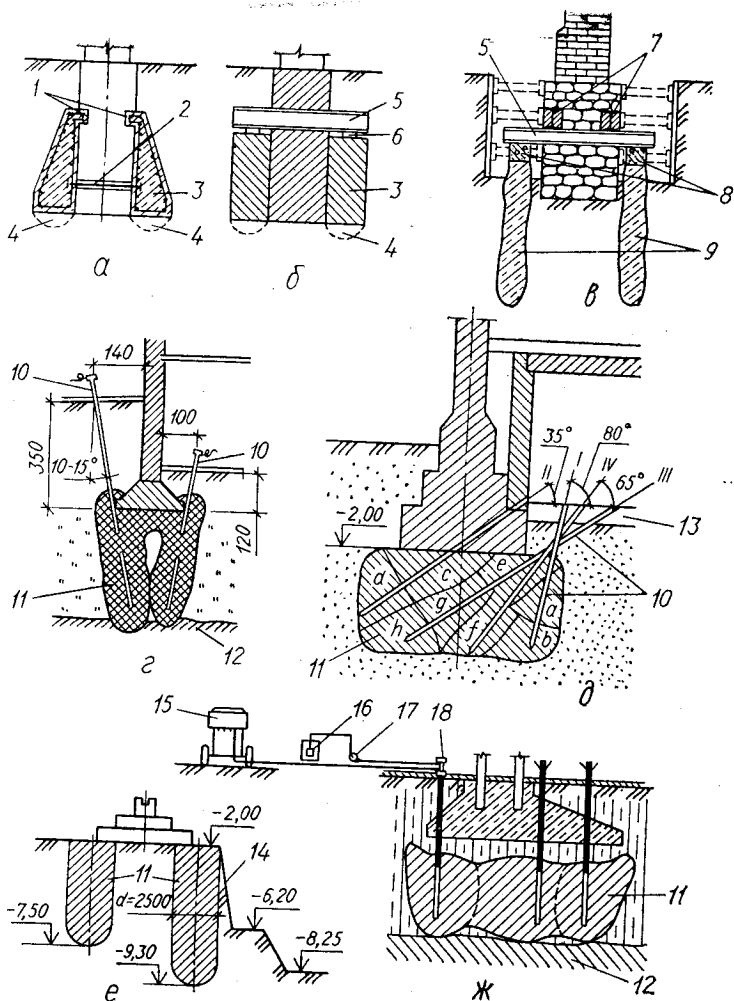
Схемы реконструкции и усиления ленточных фундаментов:
